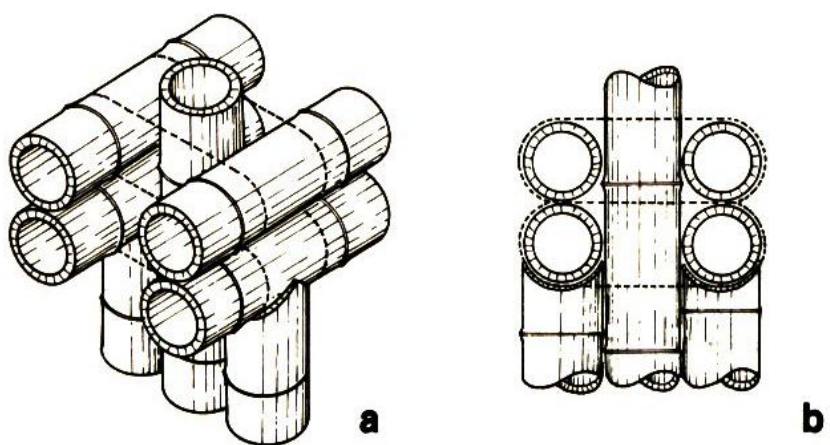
Vigas duplas laterais. Muito usadas em estruturas de pontes e galpões.
